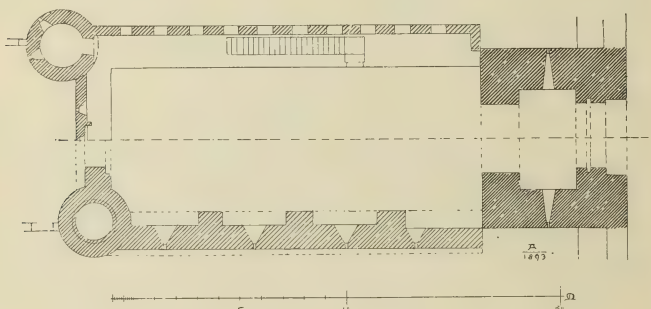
Zülrich. Grundriss des Weierthores.
